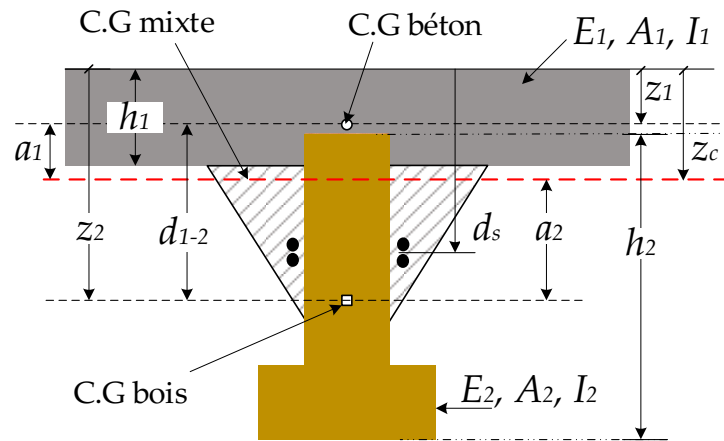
Section mixte bois-béton du spécimen d'essai avec les retombées en béton fissurées.
